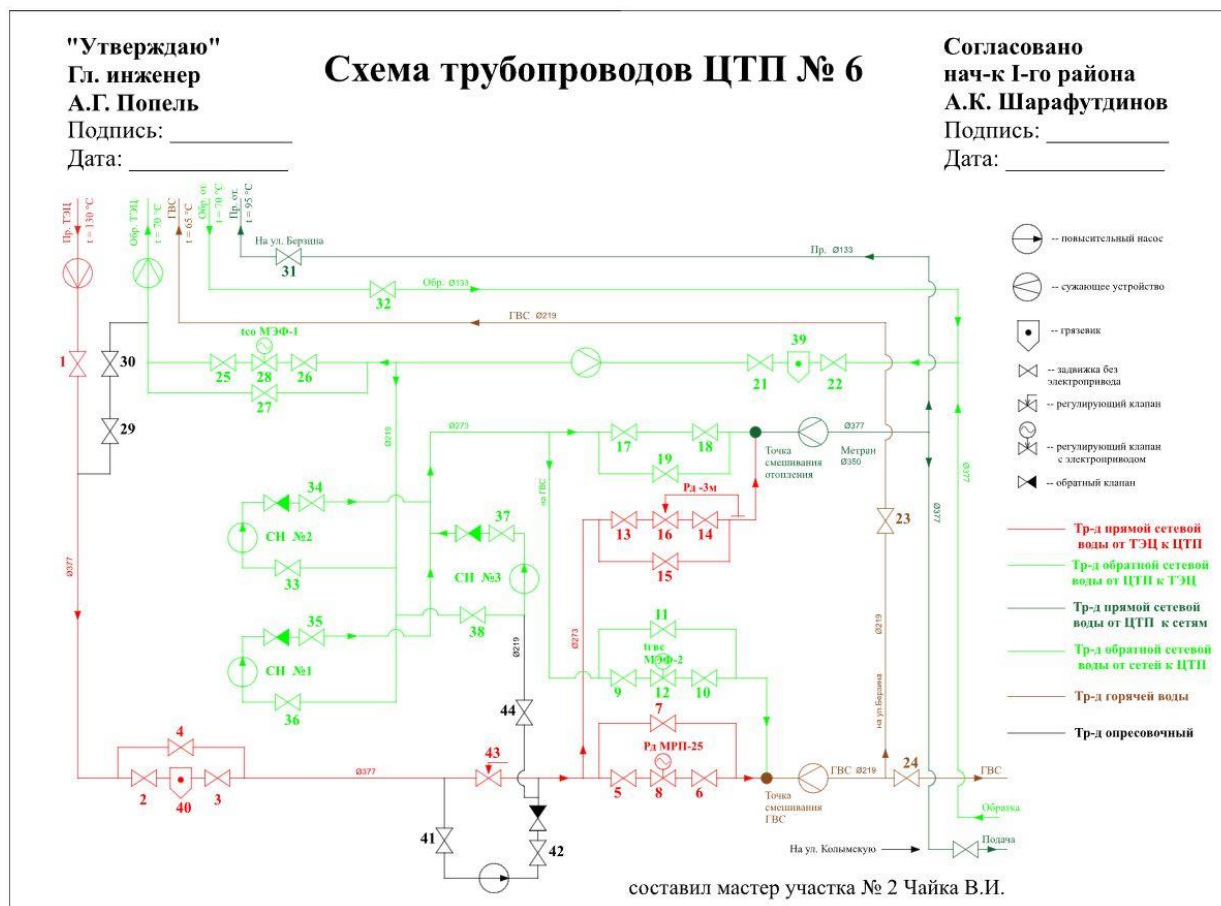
Схема трубопроводов ЦТП №6
